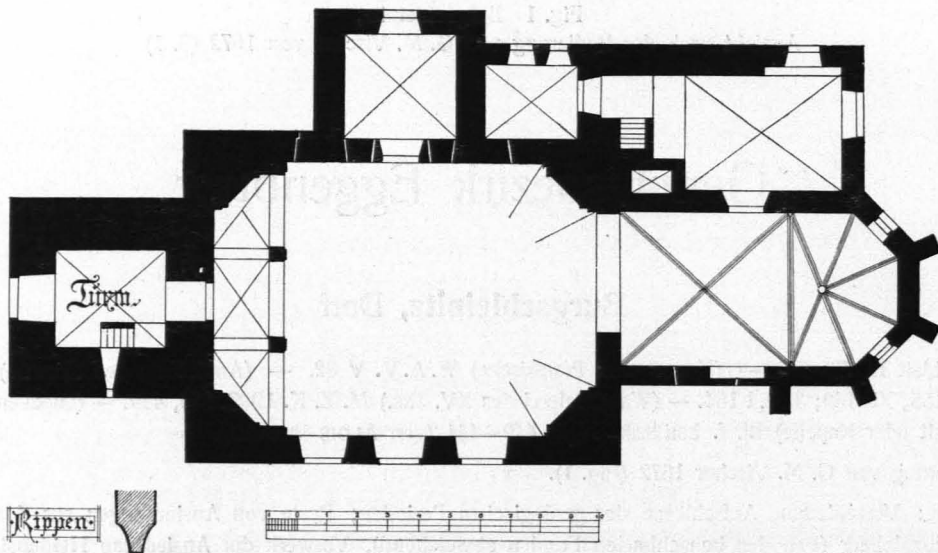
Burgschleinitz, Pfarrkirche, Grundriß 1:250 (S. 2)
